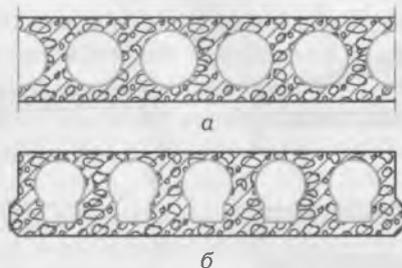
Сборные железобетонные многопустотные настилы:
